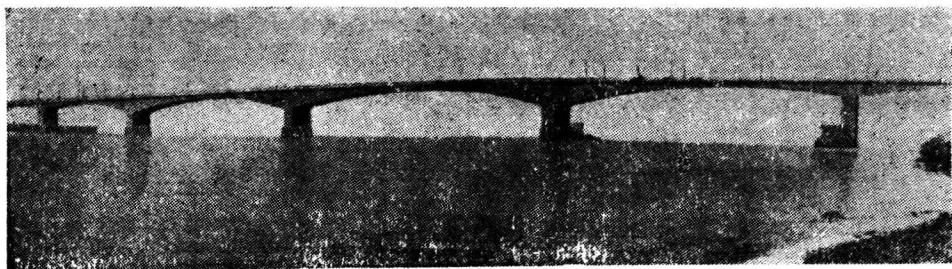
跨径为148米的框架悬臂梁式上部构造的装配式钢筋混凝土桥
